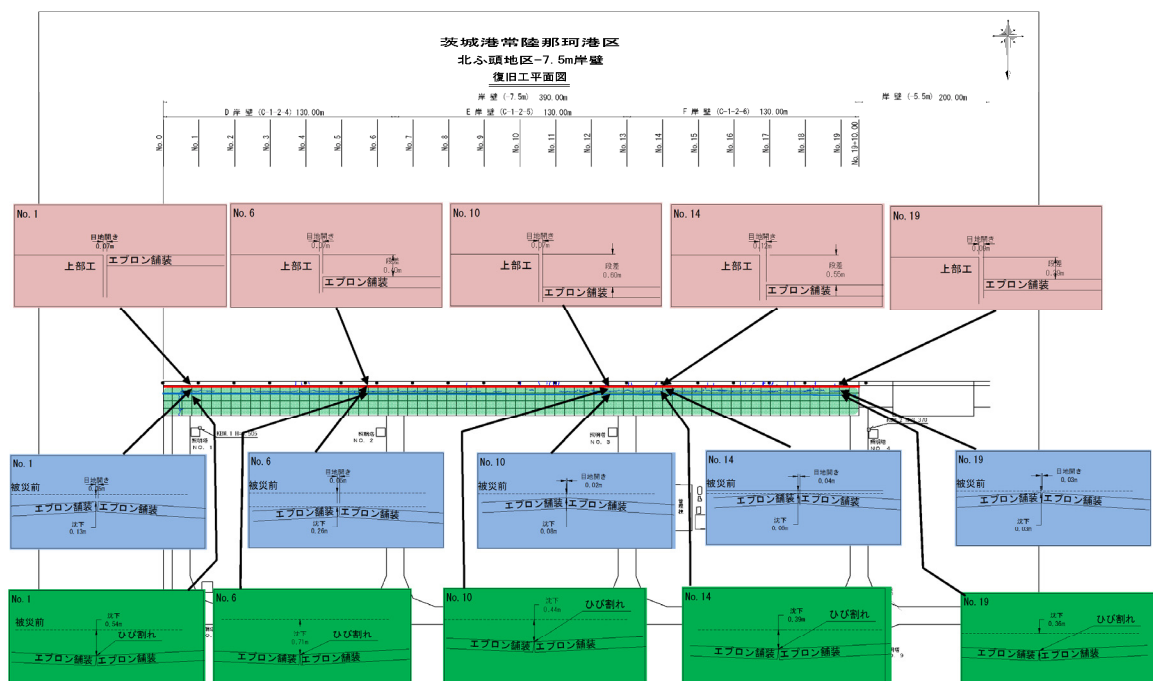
212 No.16 常陸那珂港区\_北埠頭地区 D・E・F 岸壁 (-7.5m) の平面図 (被災後)
